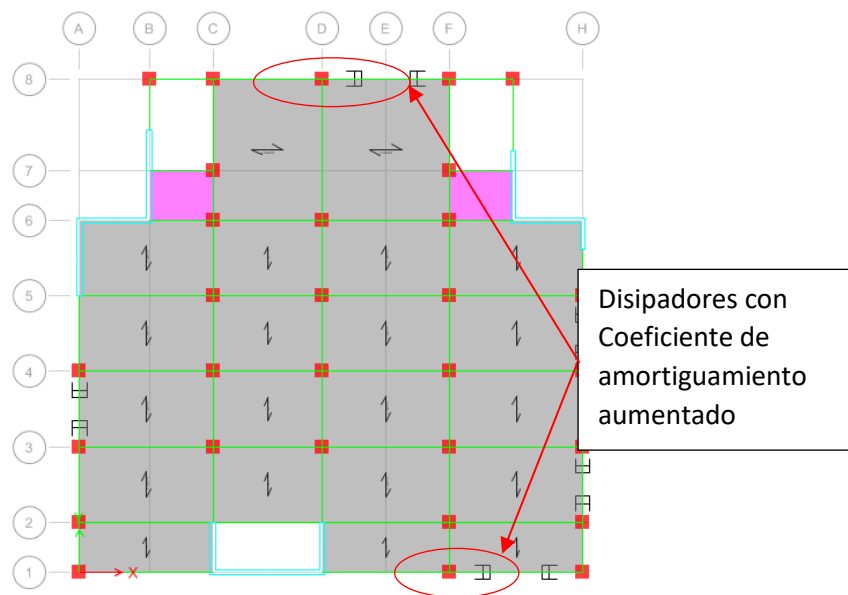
Vista en planta, quinto caso de ubicación de dispositivo
